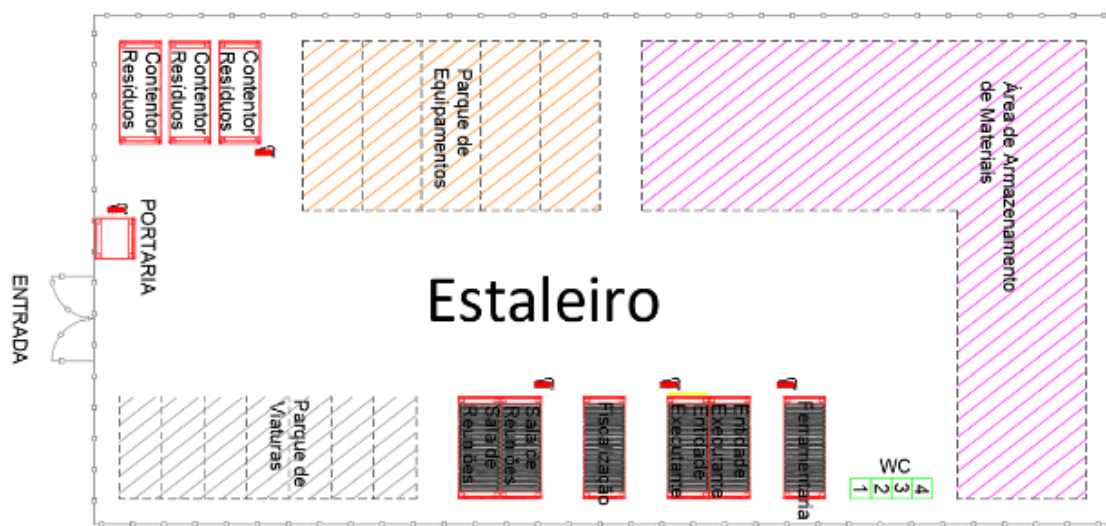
Exemplo da distribuição de um estaleiro em fase de construção
